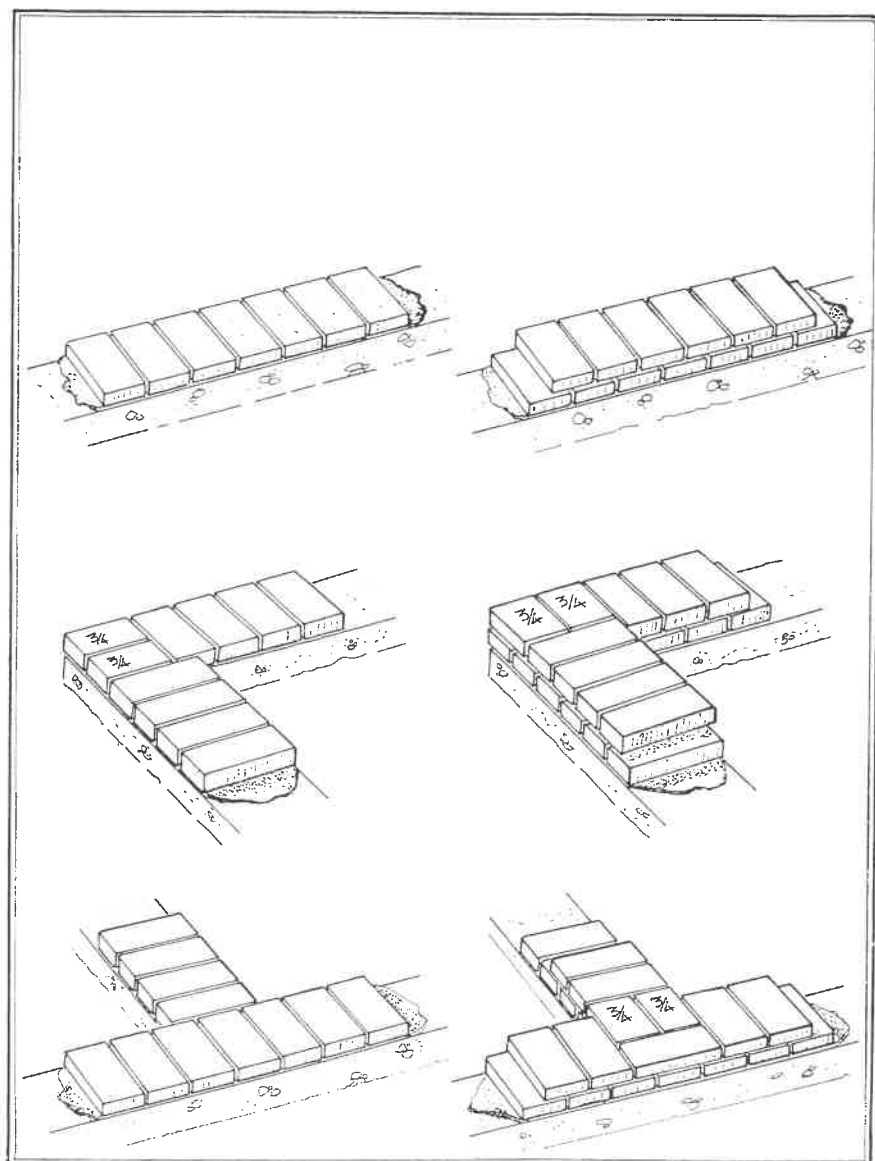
APAREJOS CON LADRILLOS RECTANGULARES
